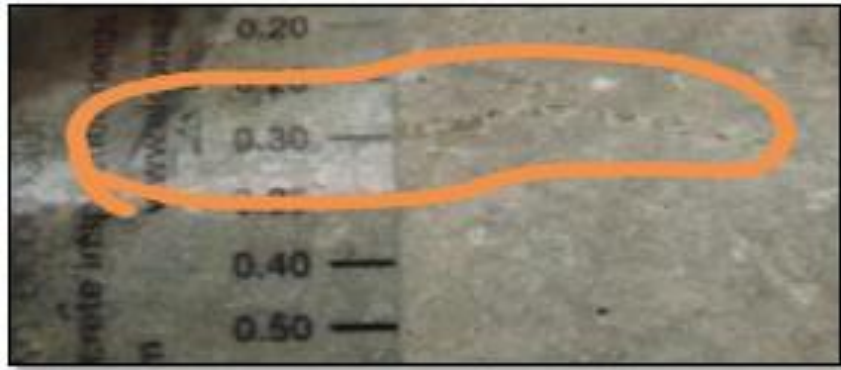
En el día 77 está grieta midió 0.30 mm de ancho.
